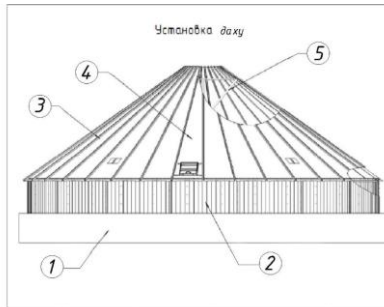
Монтаж даху на верх силосу: 1-площадка; 2-верхній пояс силосу; 3-дах; 4-секція з люком; 5-монтажна опора.
